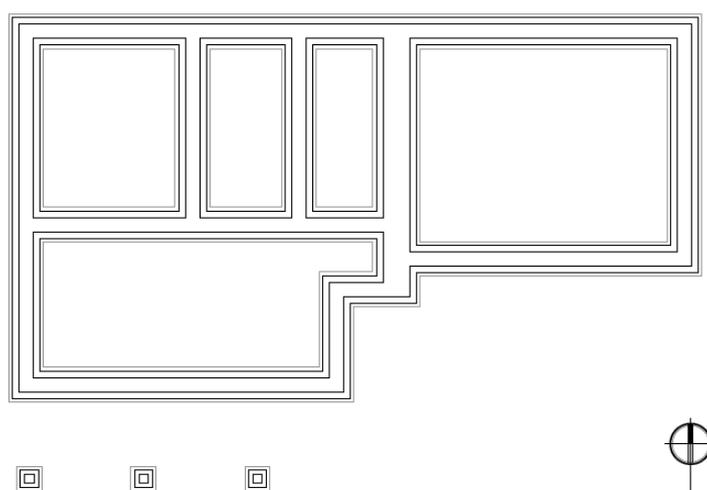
Fondazione a travi rovesce in calcestruzzo armato
